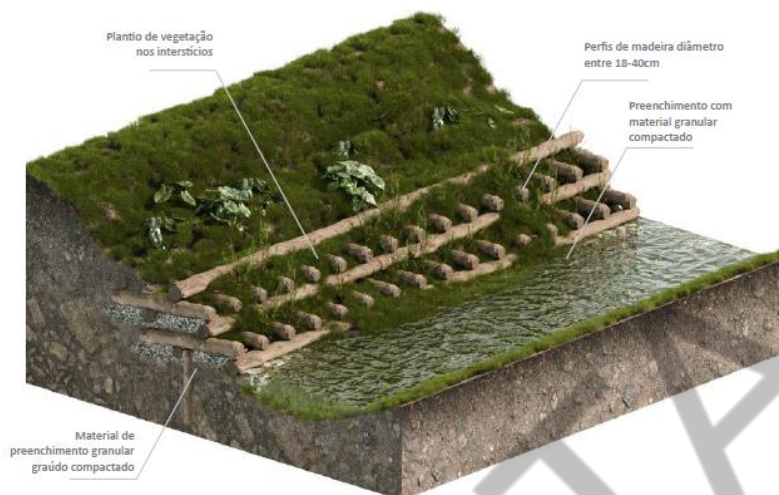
Muro de suporte vivo em madeira tipo Cribwall (Fonte: Ecosalix).
